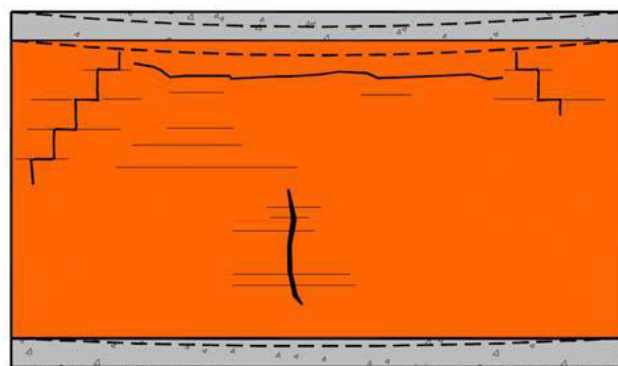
Fissuração devido à deformação do suporte inferior em relação ao elemento superior [14], adaptado de Lucas Carvalho, 1990
